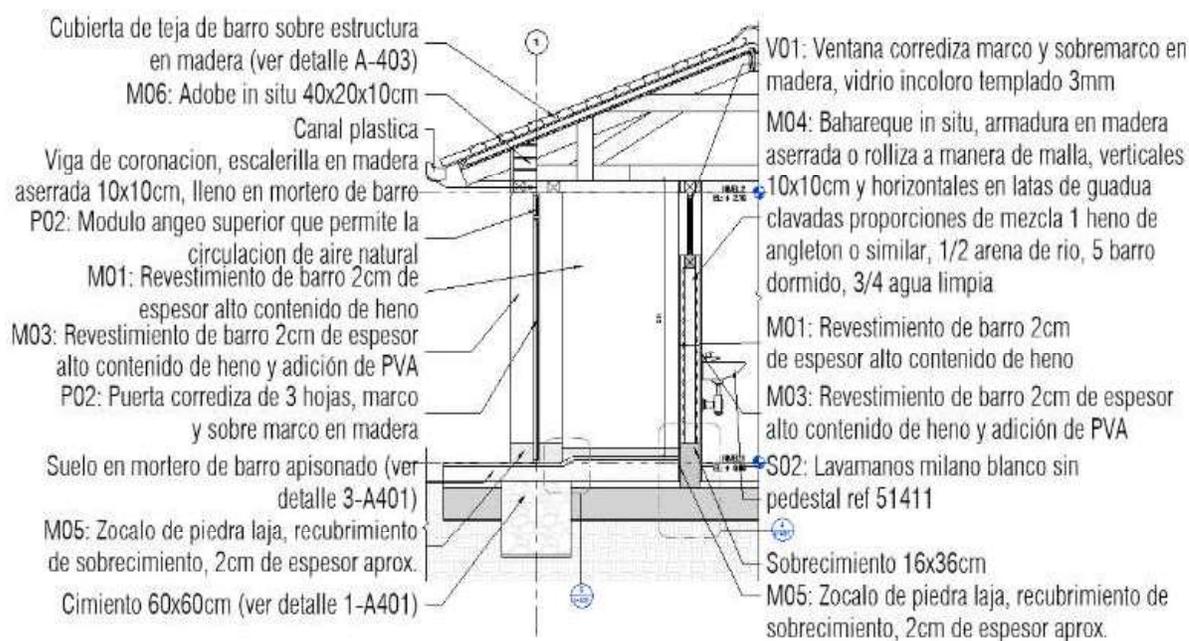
Trazado típico de las instalaciones eléctricas y cortes fachada, propuesta alternativa VISR.
